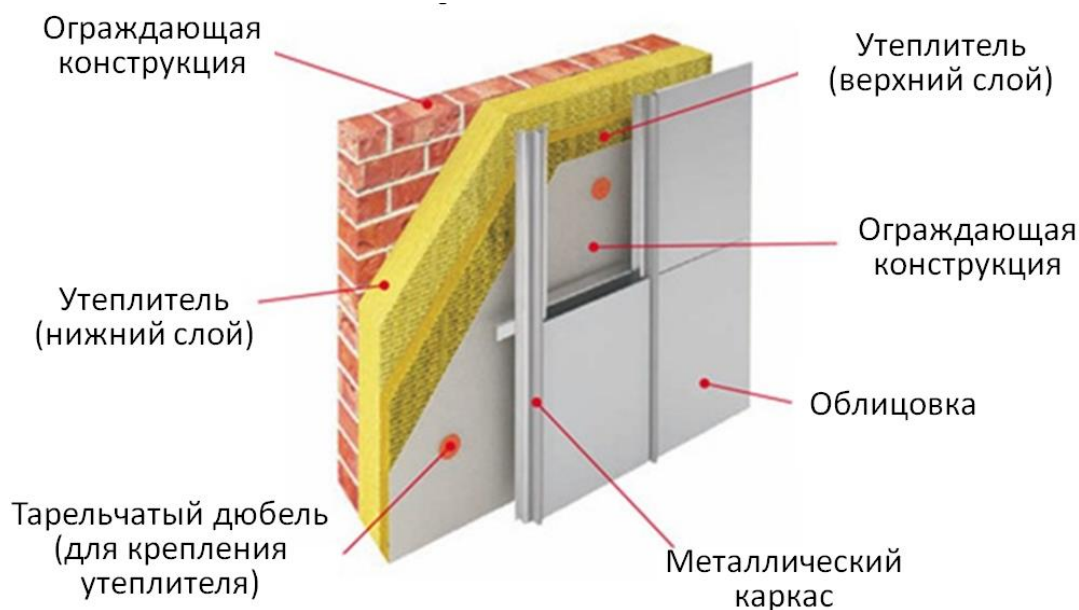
Конструктивное решение навесной фасадной системы
